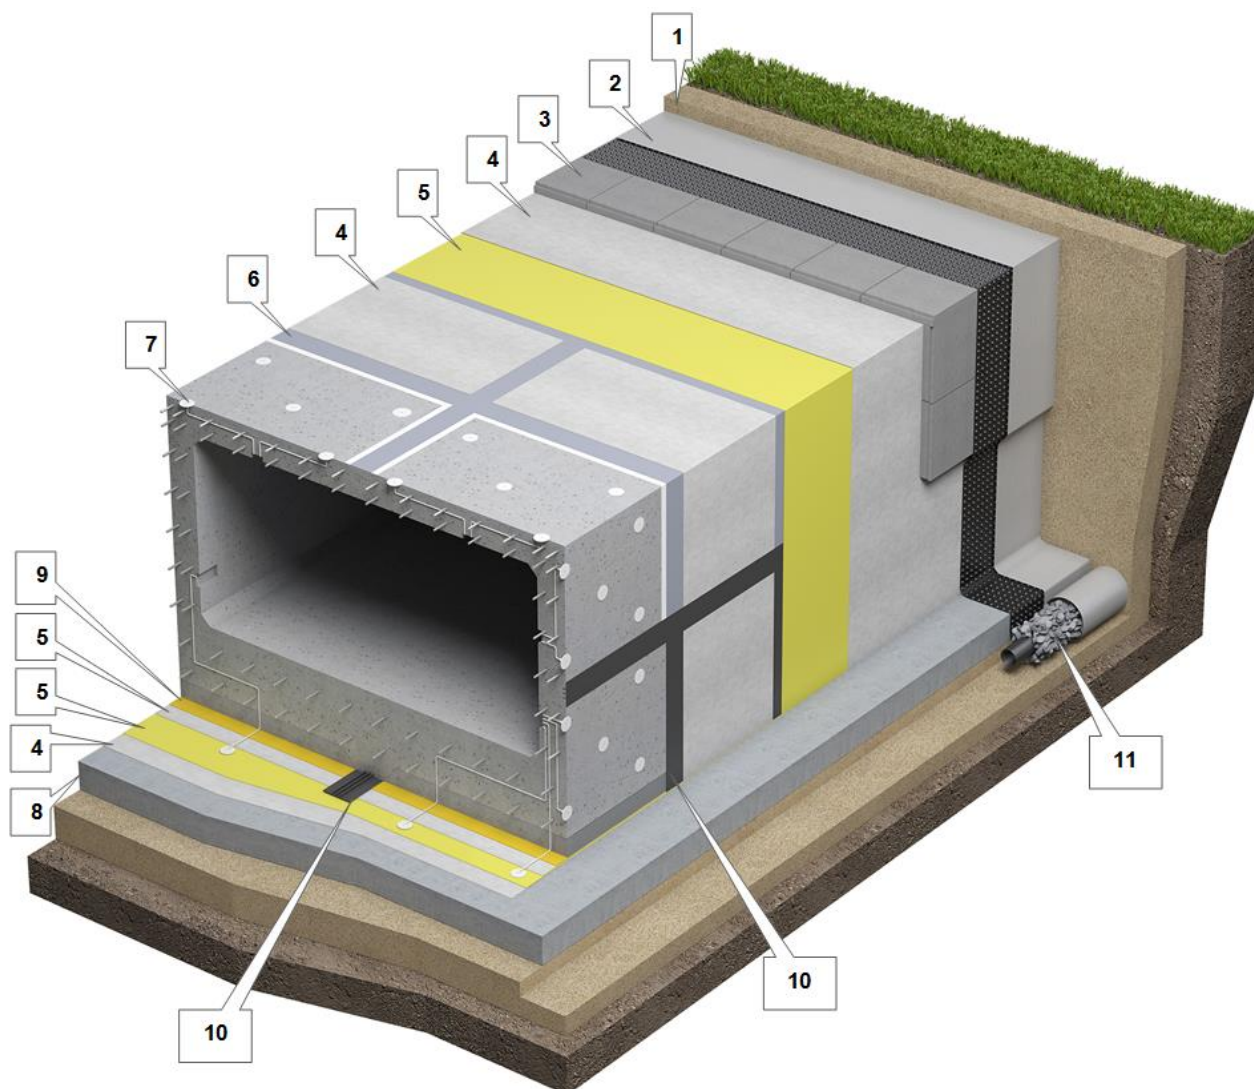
Конструкция гидроизоляционного покрытия транспортных тоннелей открытого способа производства работ, в случае если тоннель отстоит от ограждения котлована, со свободным доступом к наружным стенам и перекрытию.
